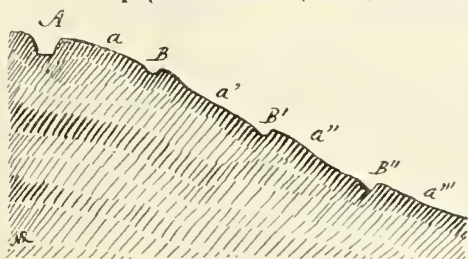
Coupe transversale et plan des rigoles de niveau sur un terrain à forte pente.
